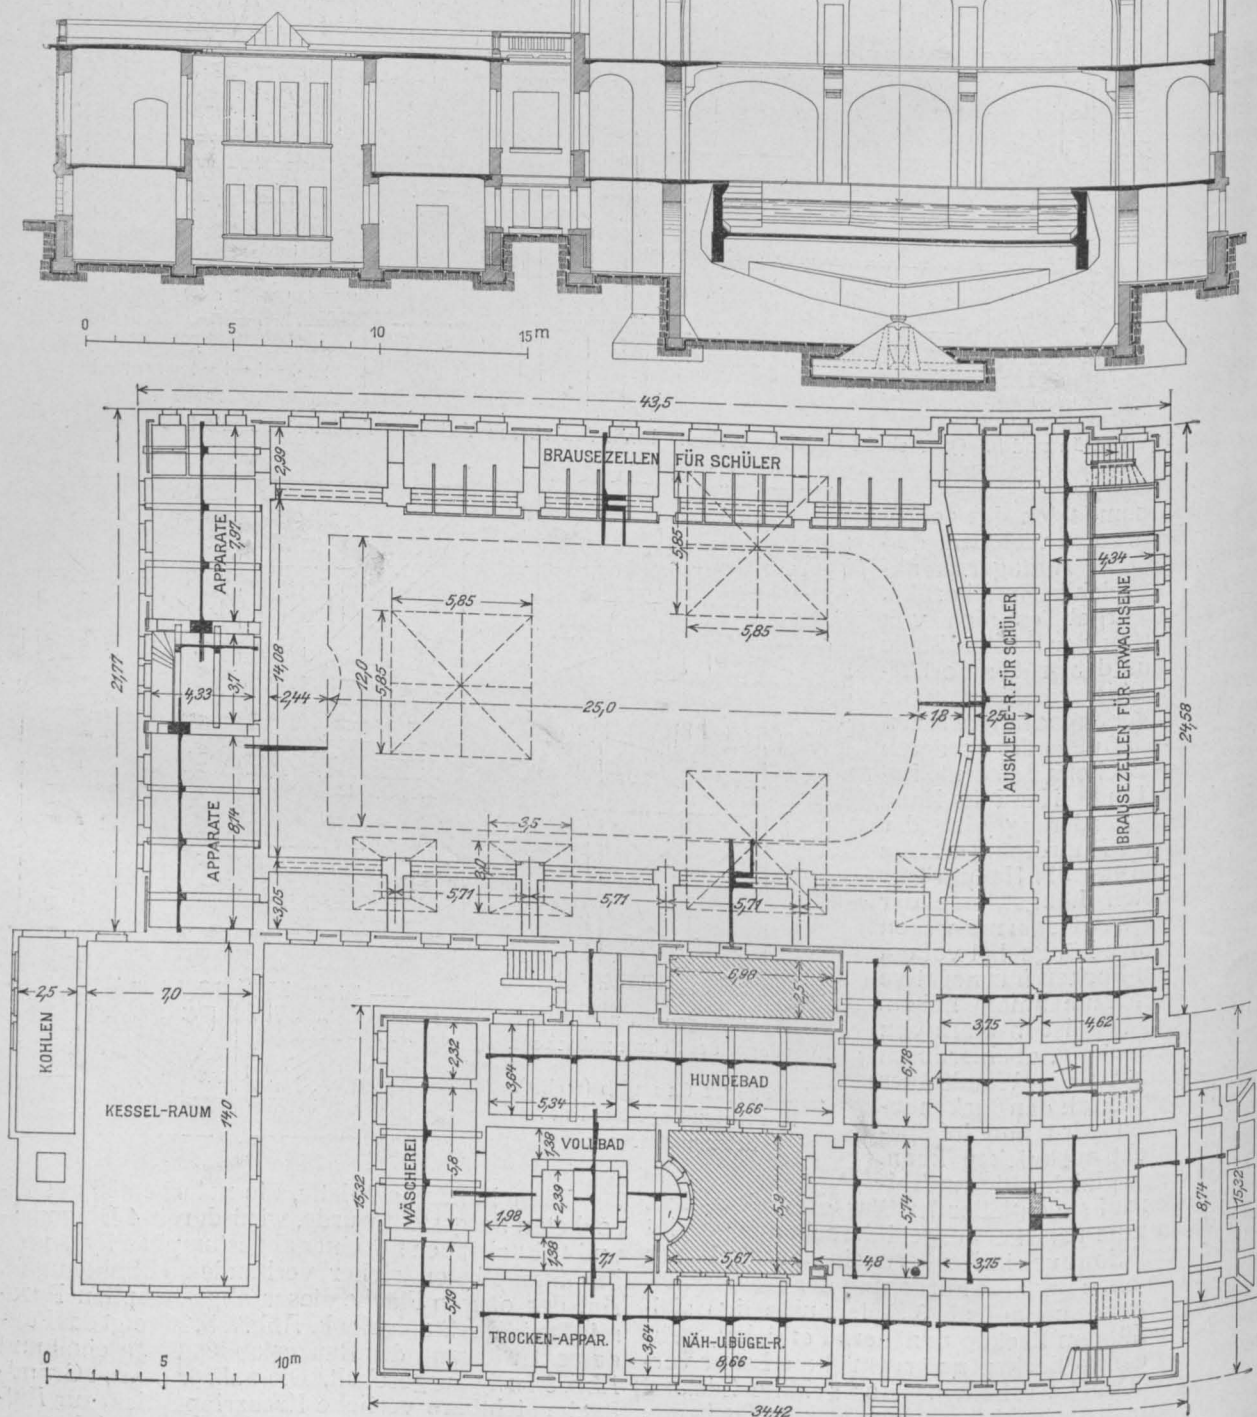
Grundriß der Gesamtanlage mit Eintragung der Eisenbetondecken.
